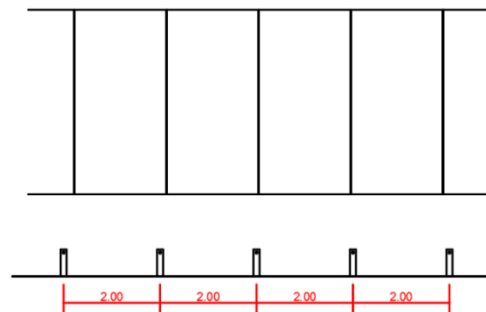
Vista en planta y lateral del obstáculo.
